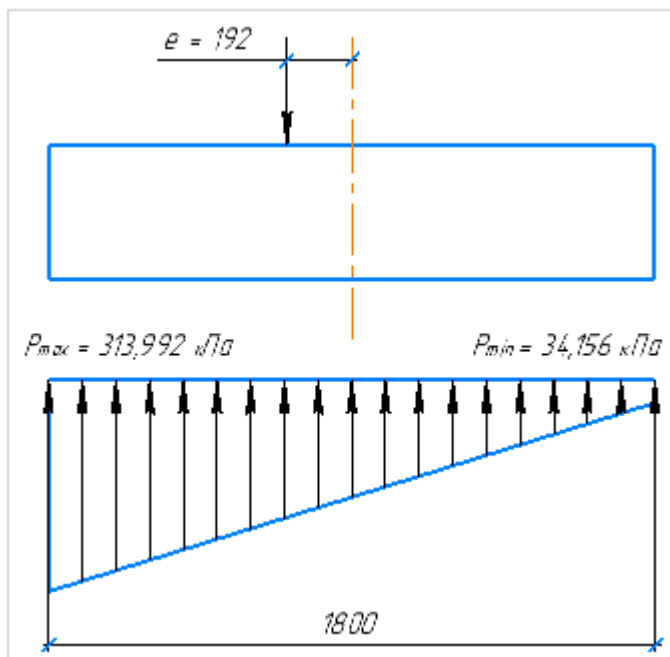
Епюра тиску під подошвою фундаменту під колону крайнього ряду.
